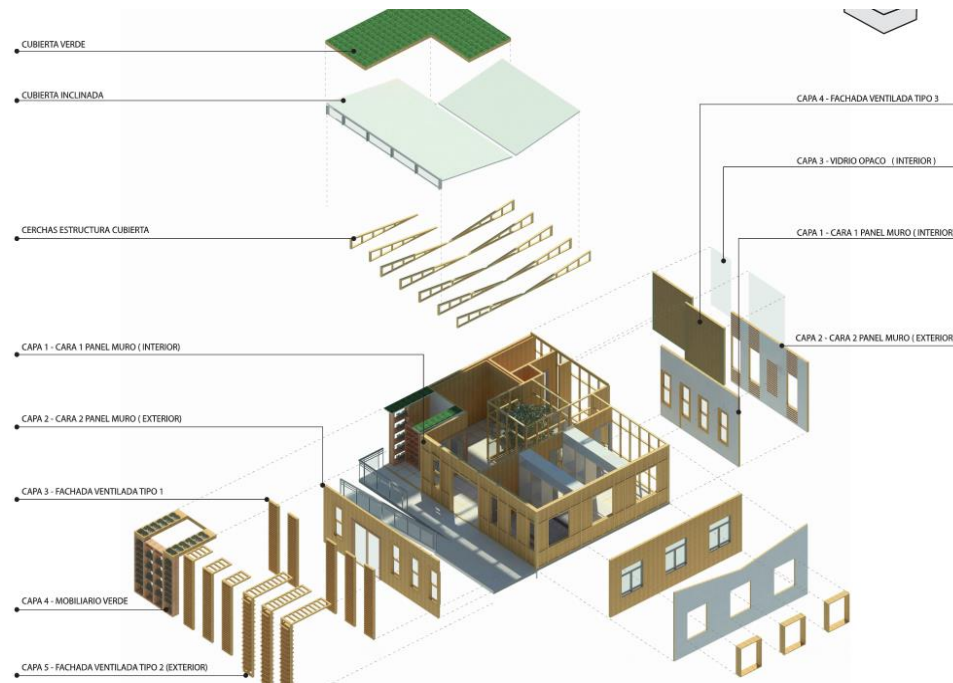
Estructuras y fachadas modulares del proyecto. Fuente: Propia (2019)
